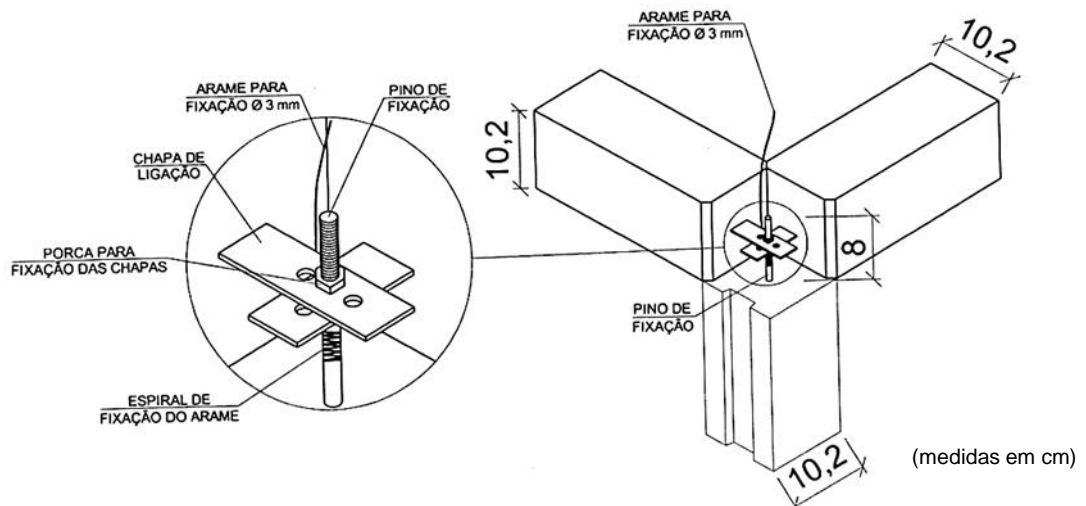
Viga cinta e detalhe da fixação com o pilar.
